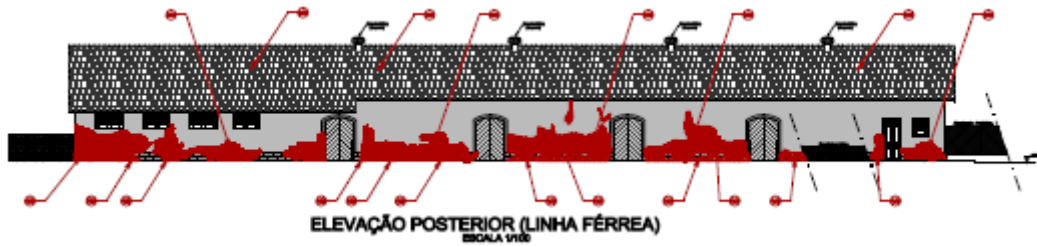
Projeção de retirada das argamassas soltas na fachada posterior.(Projeto)
